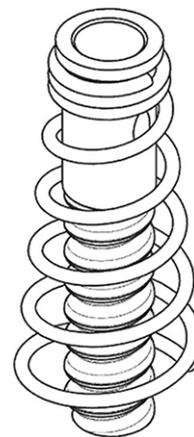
Спираль для армирования дюбеля железобетонного подрельсового основания [7]
